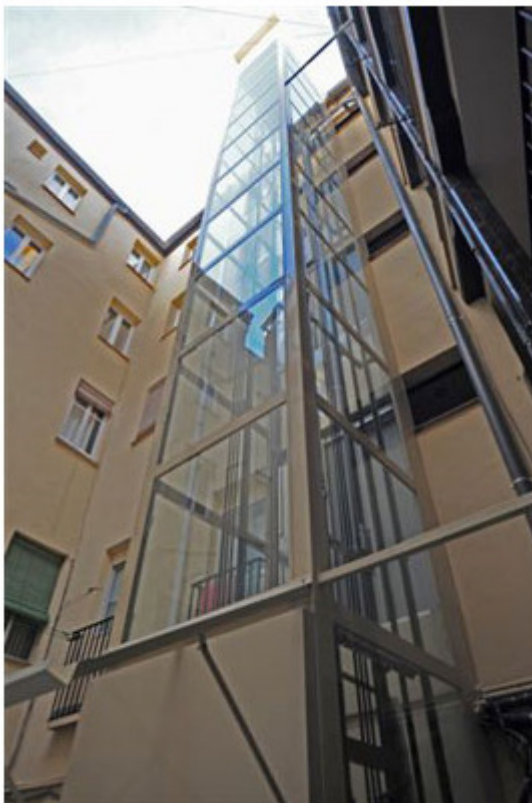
Ejemplos de estructuras metálicas para ascensores
